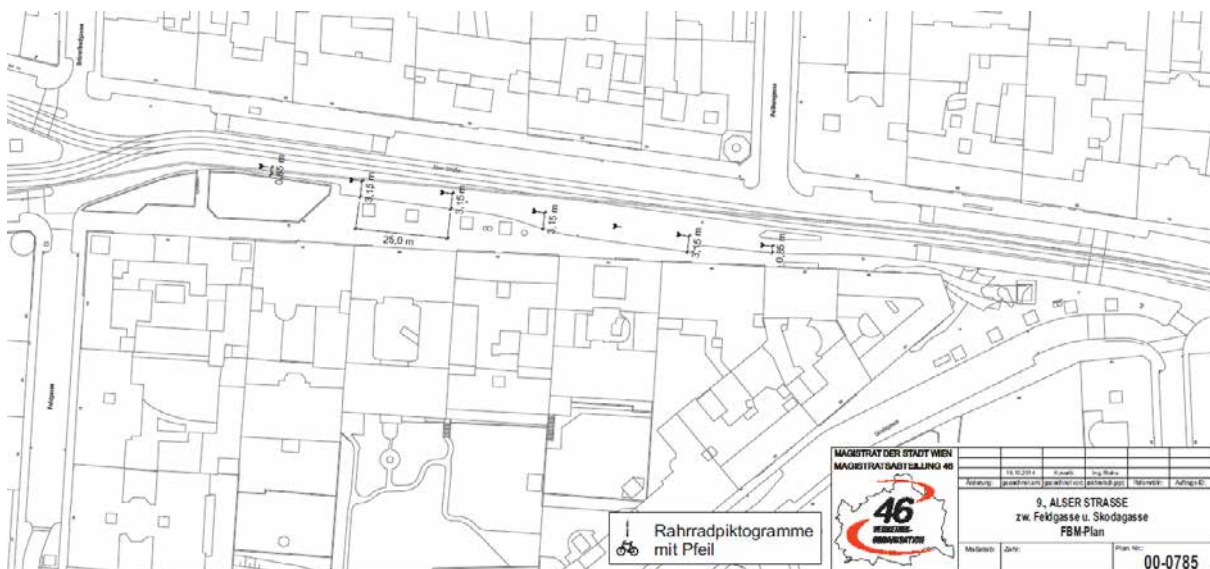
Lageplan des Untersuchungsgebietes Alser Straße
